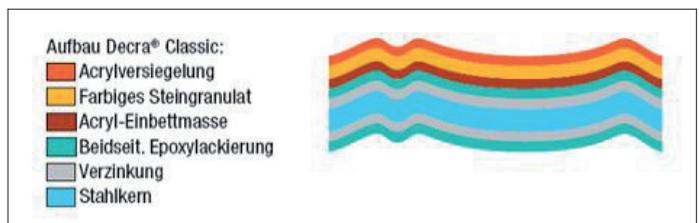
Aufbau der Dachplatte mit Stahlkern (Quelle: www.decra-dach.de).
